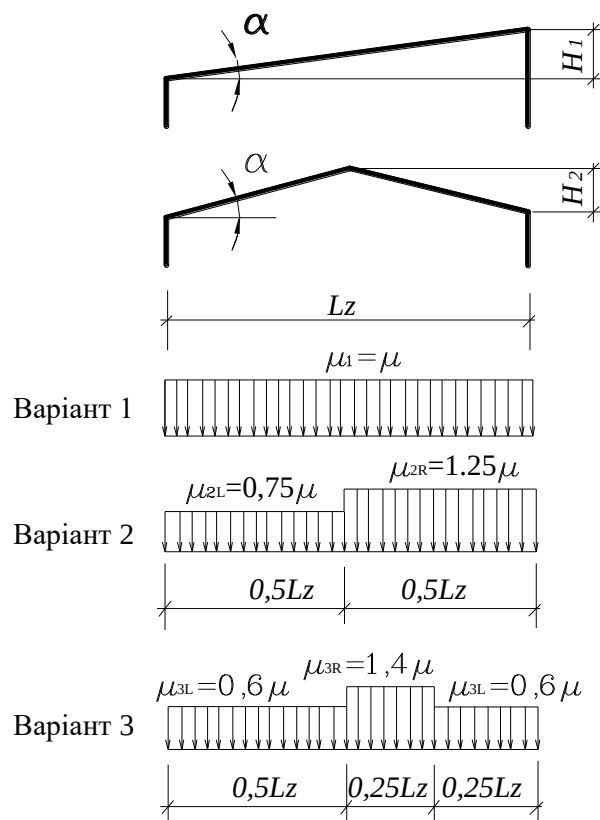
Схема снігового навантаження на будинки з односхилими та двосхилими покриттями
